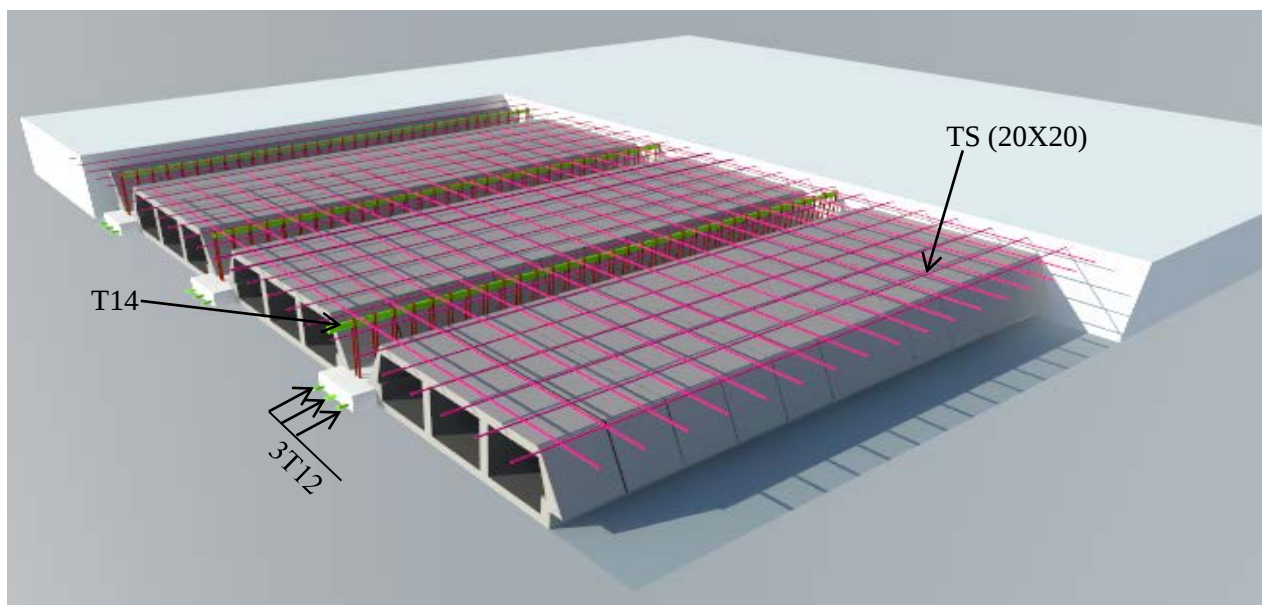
Schémas de ferrailage de plancher corps creux étage commerce en 3D.
